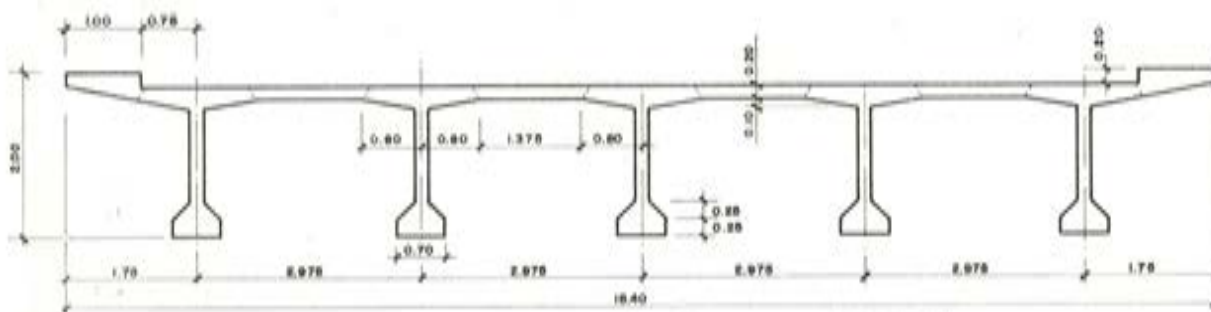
Viaducto de Torre Baró (sección transversal del dintel).
